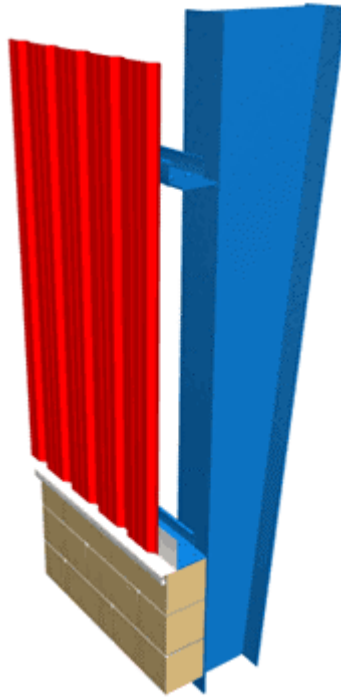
Detalle panel chapa grecada simple con su unión a la estructura
